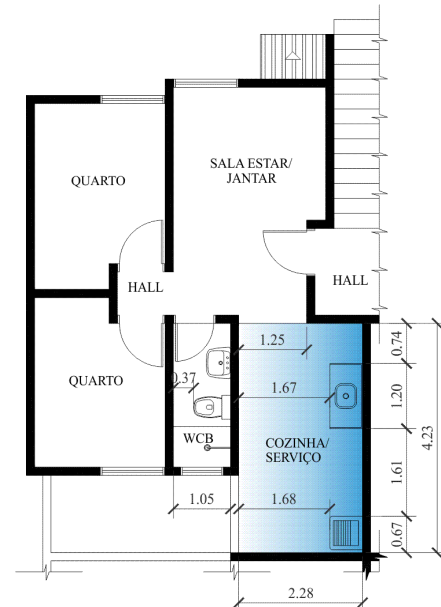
Planta Baixa Pav. Tipo: Setor de Serviço do Residencial Ouro Preto I (sem escala)
